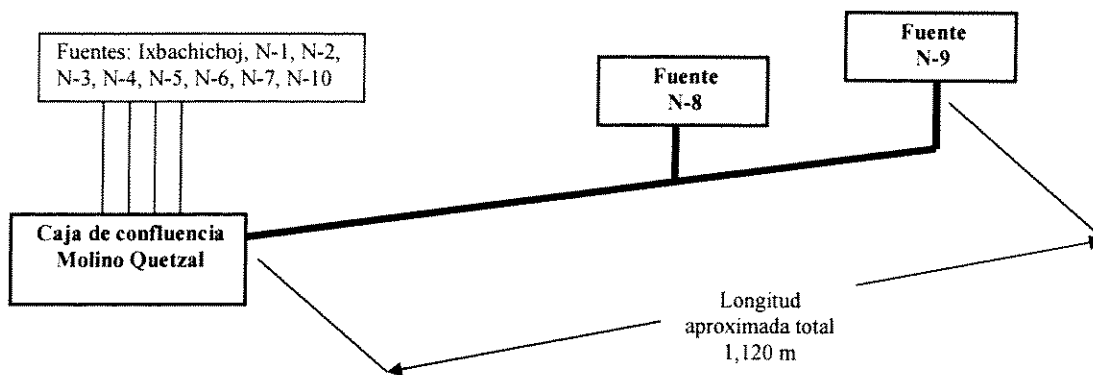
Perfil de reconstrucción de la tubería para las Fuentes Molino Viejo N-8 & N-9
